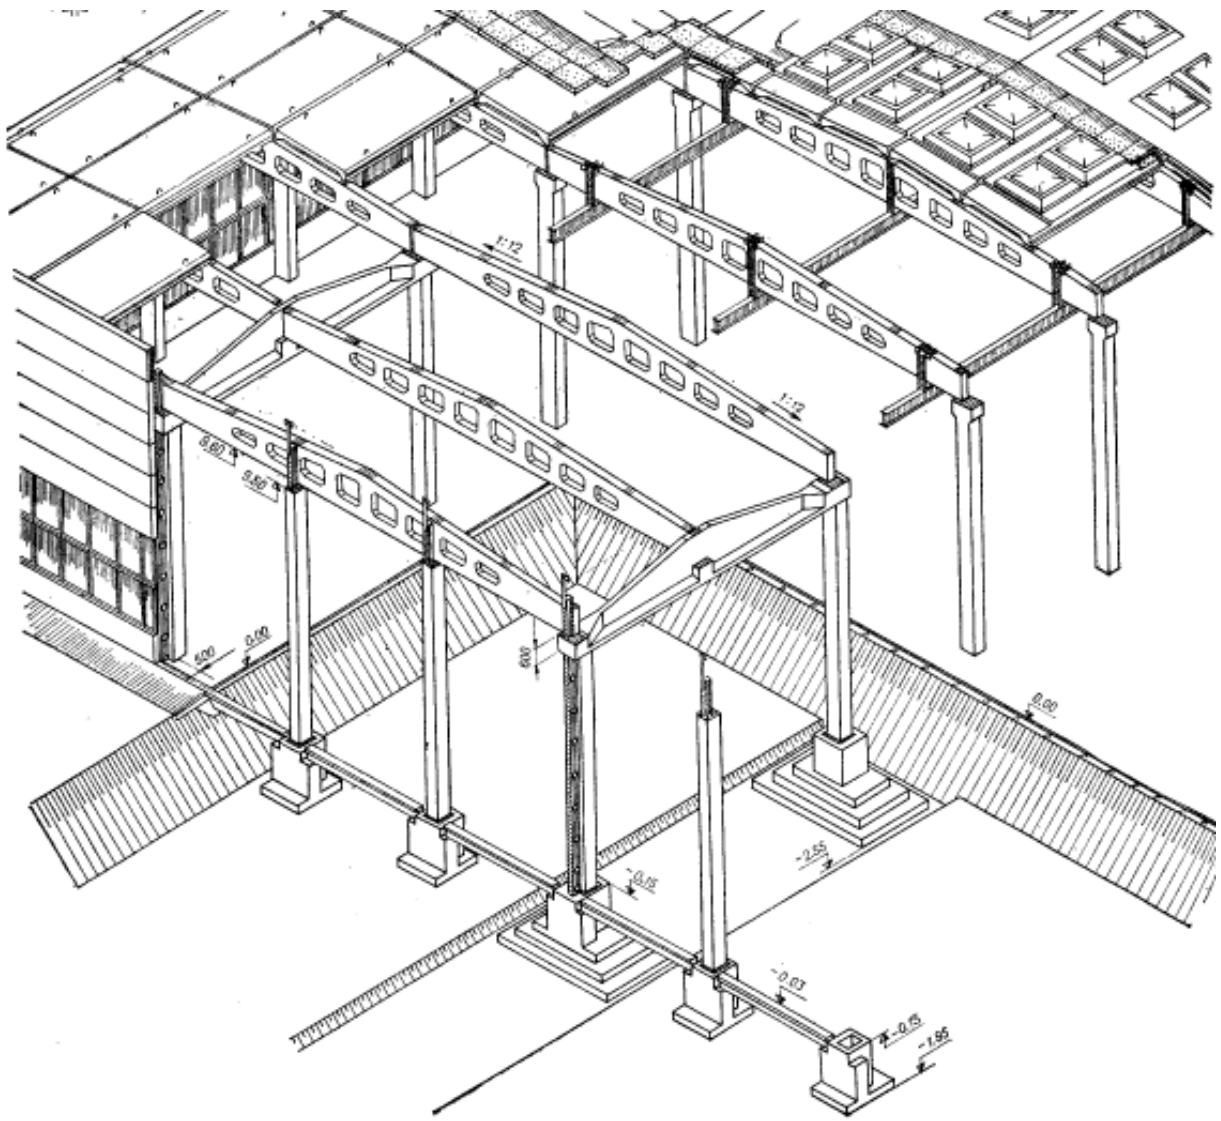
Збірний залізобетонний каркас одноповерхової промислової будівлі і схеми в'язей (1-ий варіант):
